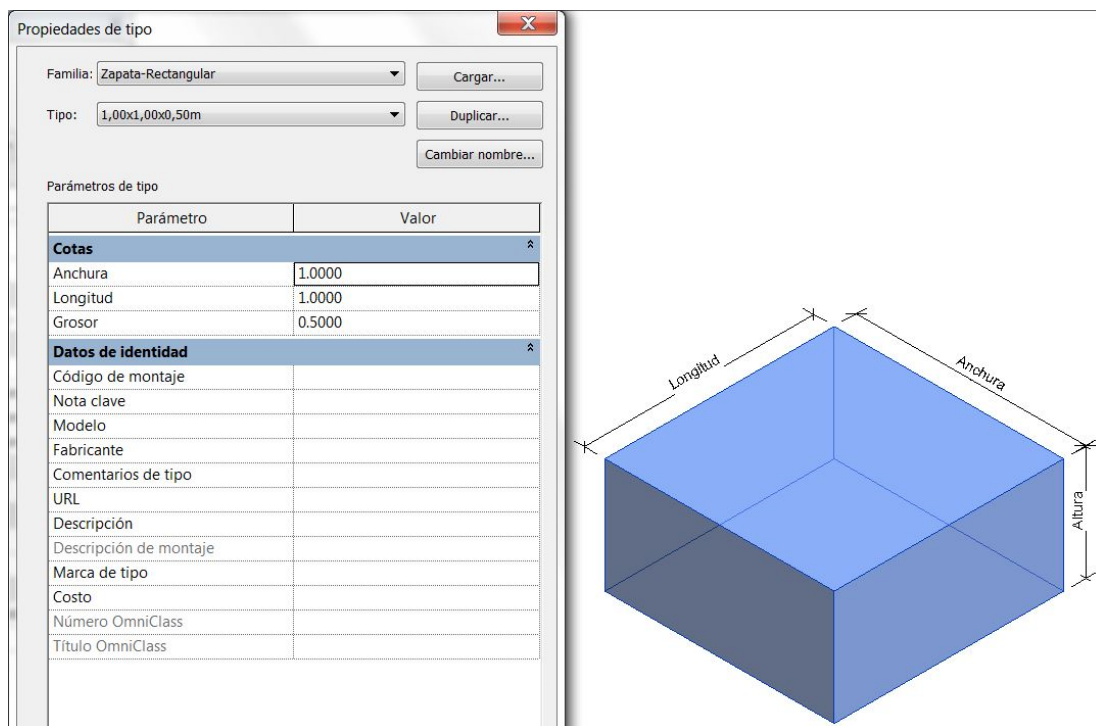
Propiedades de tipo de zapatas de hormigón.
